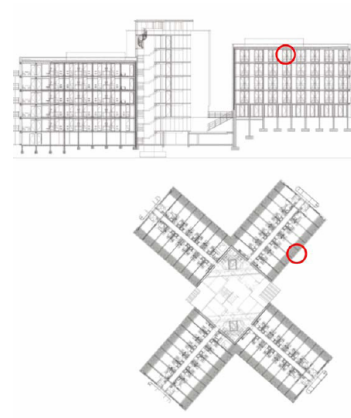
Grundriss und Schnitt mit eingezeichneter Messstation auf 10 m Höhe
